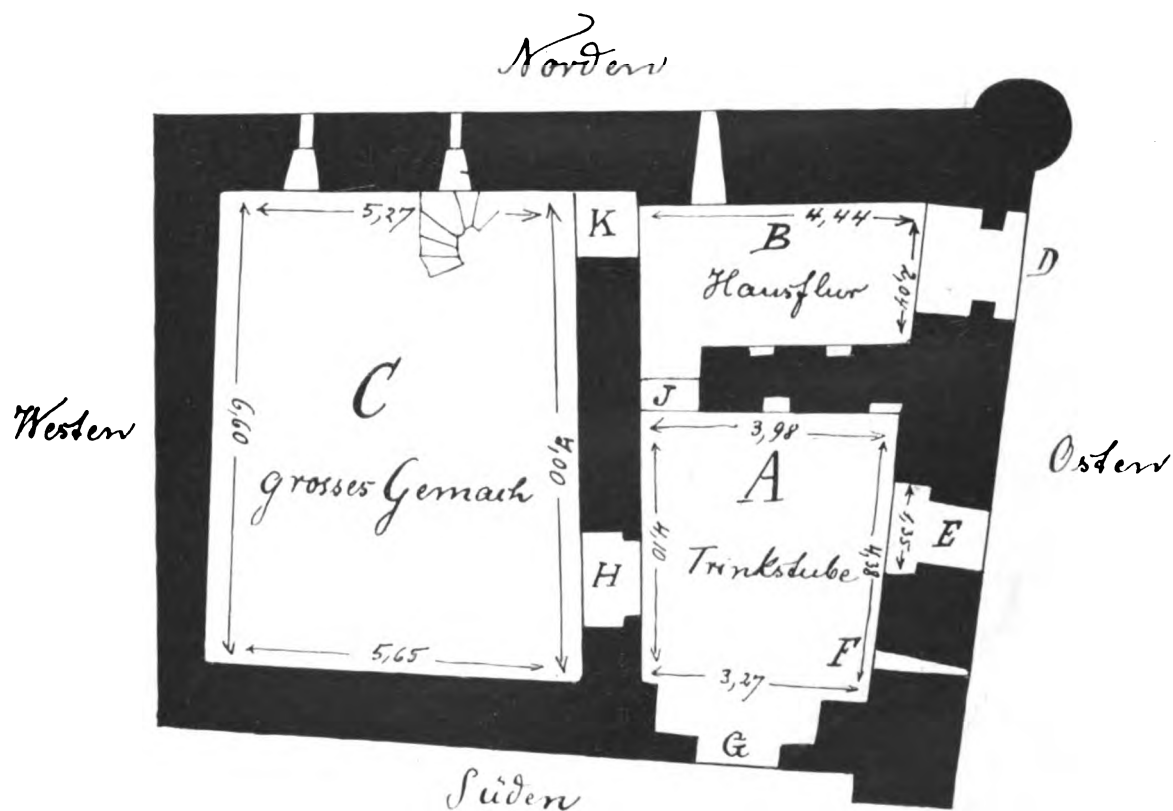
Grundriss des Erdgeschosses des alten Hessenhofes.
